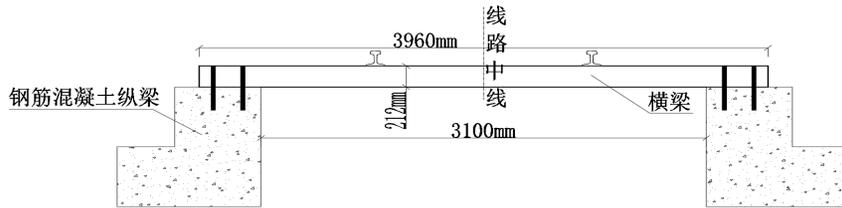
采用钢筋混凝土纵梁的D型便梁工作断面示意图
